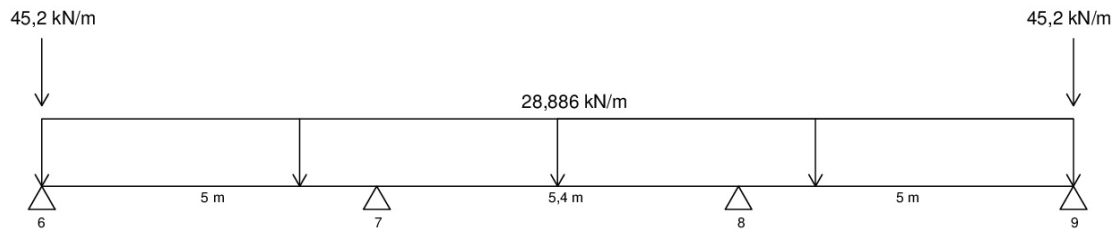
Carga permanente sobre el pórtico 6-7-8-9 de la primera planta.
